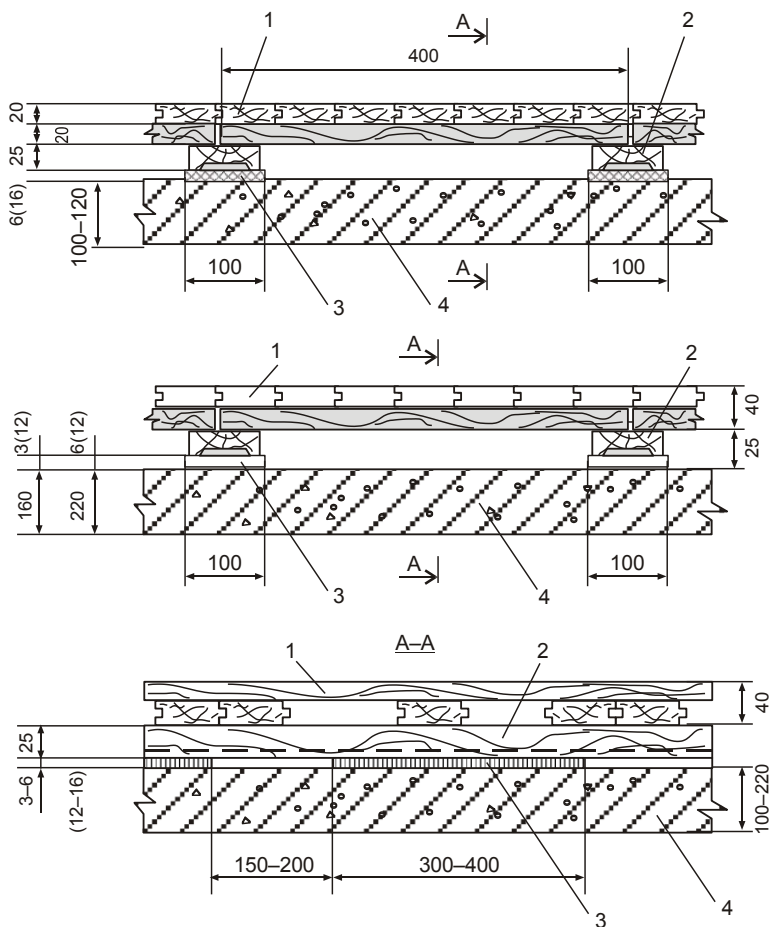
Конструктивные схемы междуэтажных перекрытий в жилых зданиях (пол из щитов). В скобках указана толщина звукоизоляционной прокладки из ДВП (между участками прокладки длиной 300—400 мм интервал 150—200 мм): 1 — щиты пола с распорными брусками; 2 — лаги акустически эффективные 25×80 мм; 3 — звукоизоляционная прокладка из изоляционного картона или мягких ДВП; 4 — плиты (настилы) перекрытия $h = 100; 120; 160; 220$ мм
